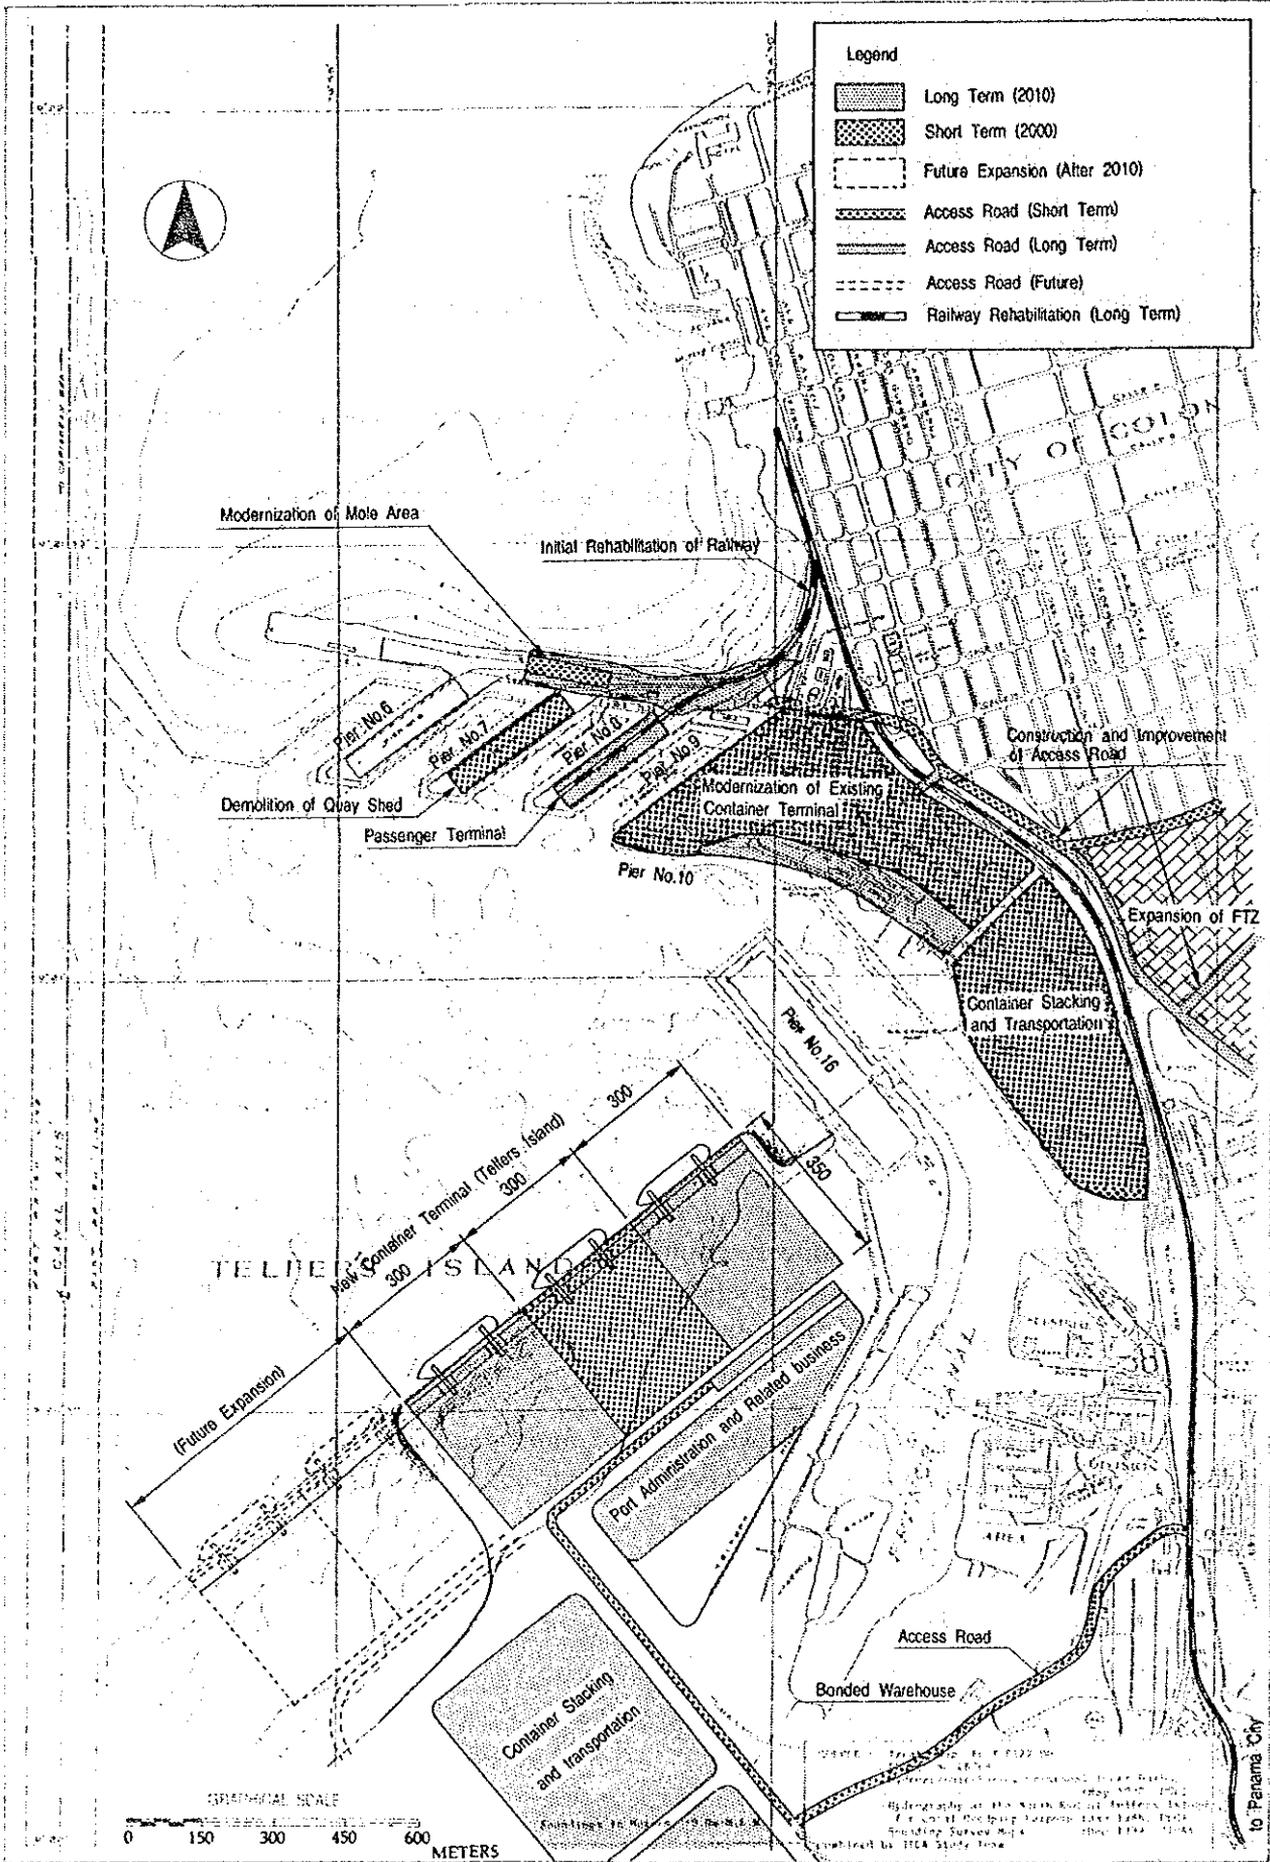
Principales Proyectos en Plan Maestro (2010)
